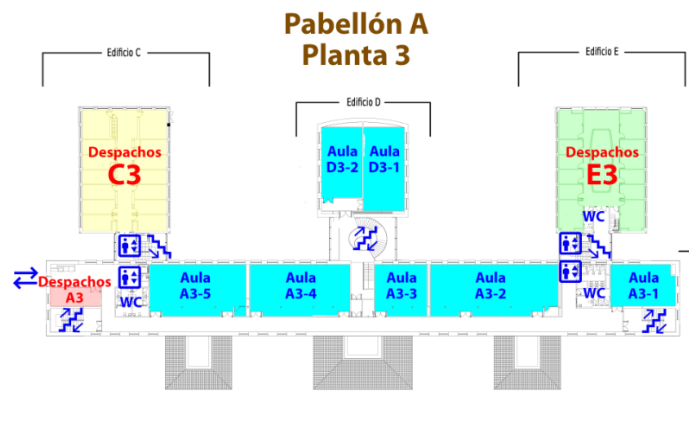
Plano Pabellón A en la planta 3. Fuente: Planos de la Facultad. <https://fyl.unizar.es/planos-de-la-facultad>
